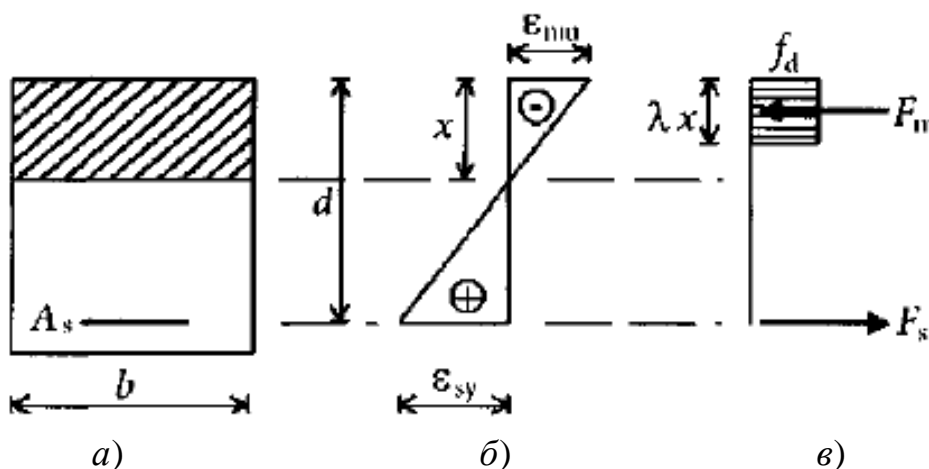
Розрахункова схема армокам'яної кладки з поздовжнім армуванням при згинанні ([1]): а – поперечний переріз; б – епюра деформацій; в – внутрішні зусилля в перерізі
